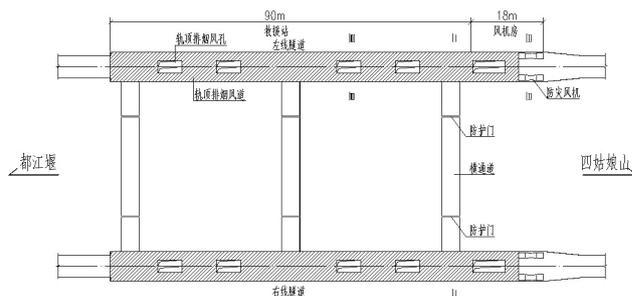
紧急救援站轨顶排烟风道平面布置示意图（单位：m）
